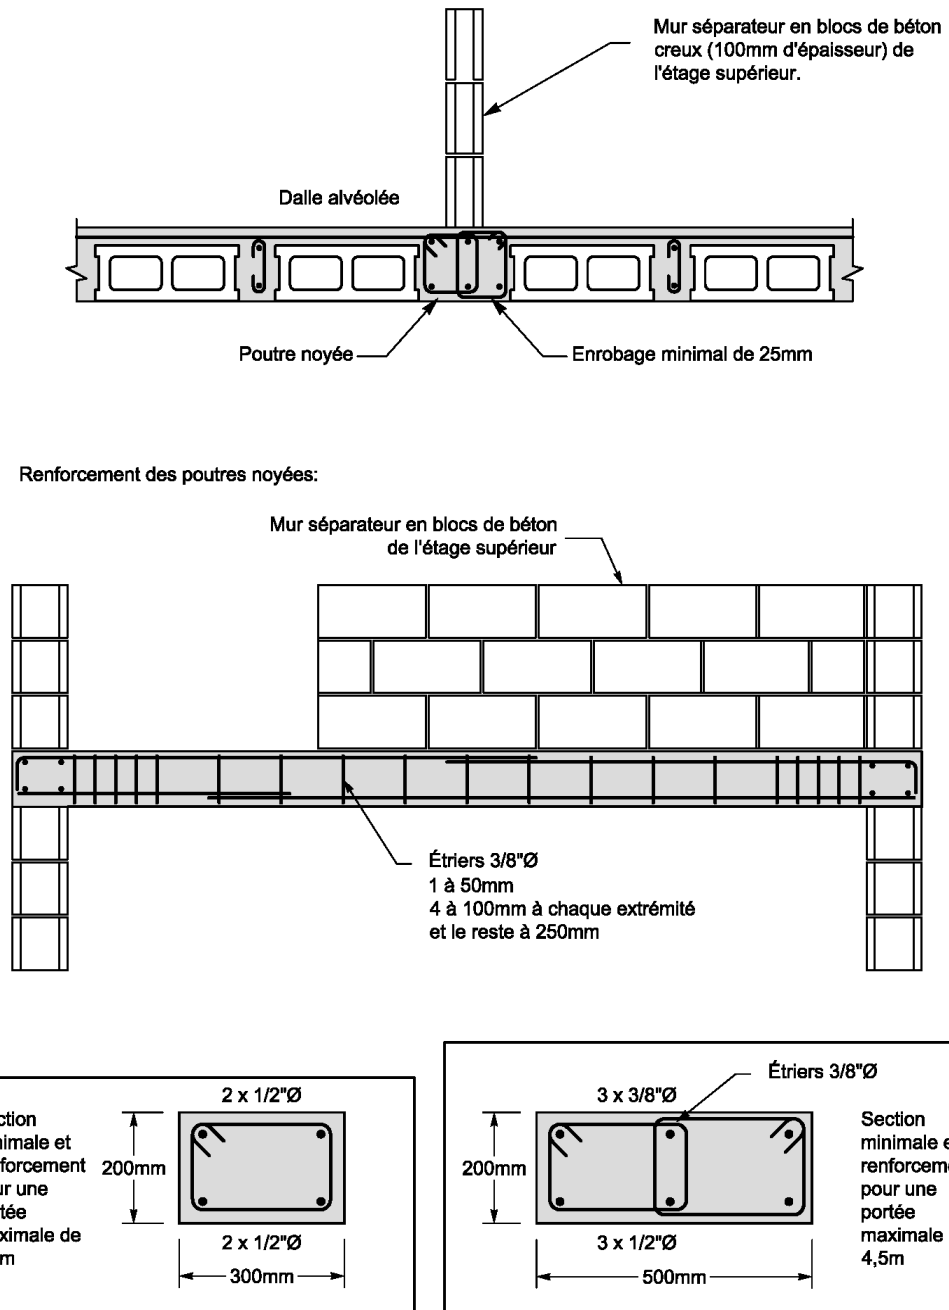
Poutres noyées dans une dalle alvéolée
